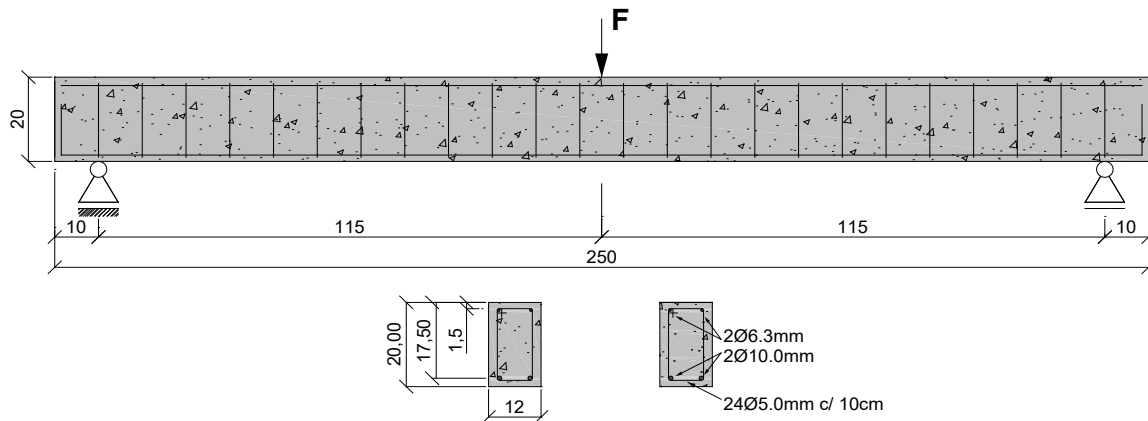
Característica das vigas de concreto armado. Unidades em cm.
